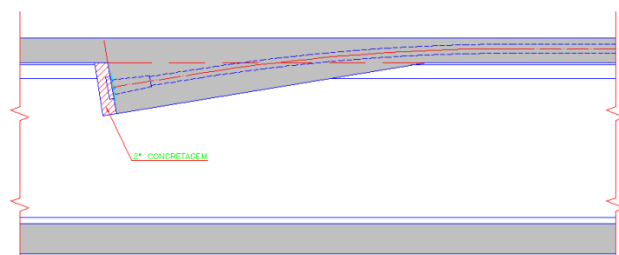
Detalhe Longitudinal do Nicho de Protensão.
